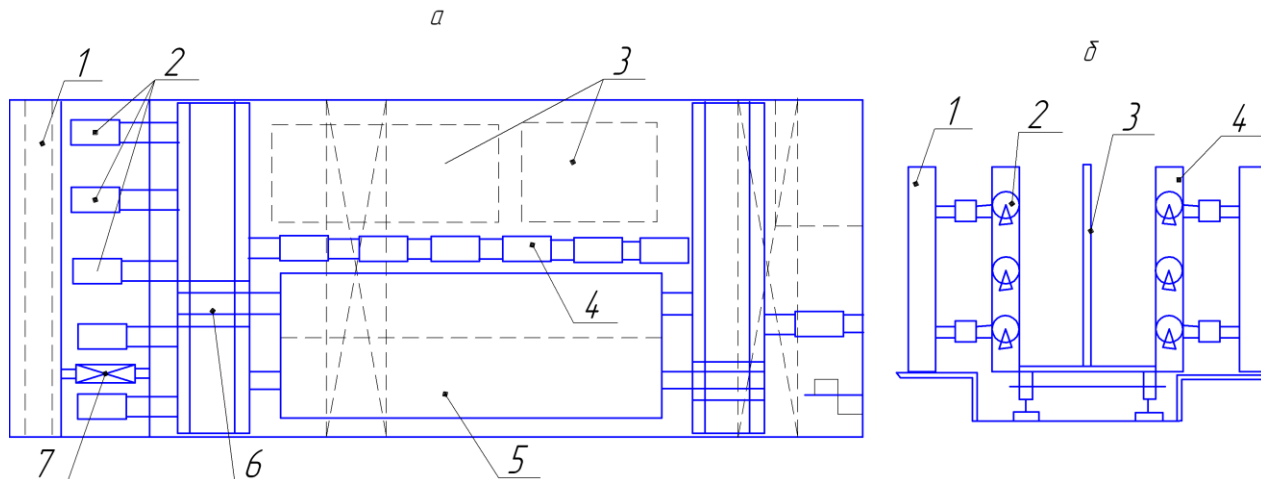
Схема кассетно-конвейерной линии изготовления панелей внутренних стен, перегородок и плит перекрытий с двухстадийной тепловой обработкой:
